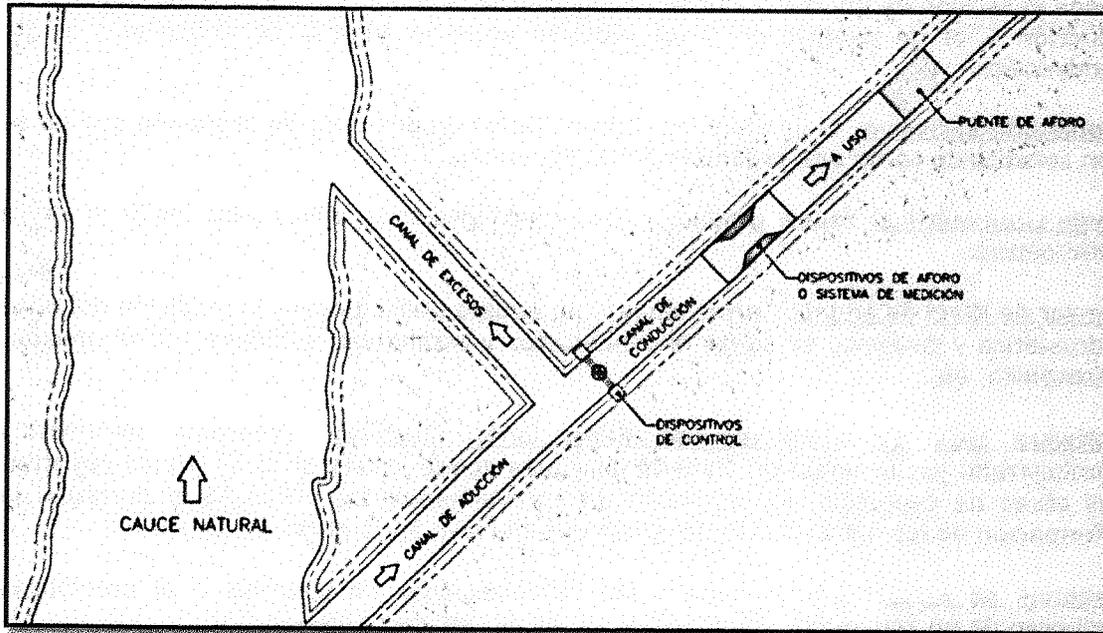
Esquema general de la obra de captación situada en cauce natural y su respectivo canal de aducción, canal de excesos, compuerta, canal de conducción, dispositivos de aforo o sistema de medición y puente de aforo o sección para aforo DGA.
